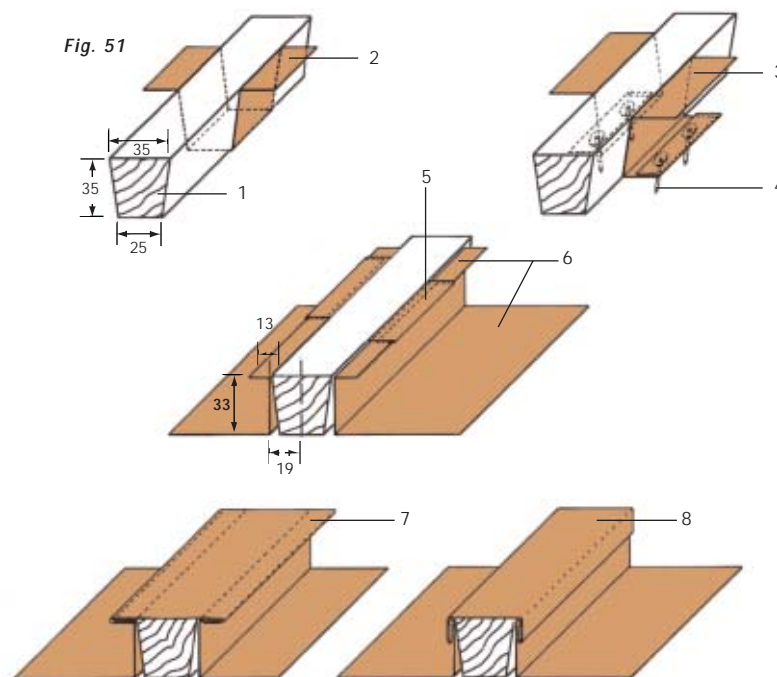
Junta elevada longitudinal com caibro de madeira.
